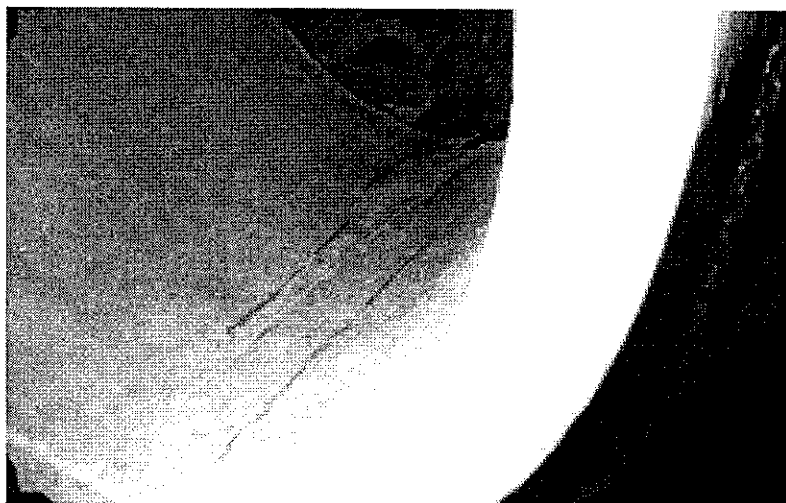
Muestra la falla producida en la tubería con diámetro de 42" y área de acero de refuerzo, la falla se produce a lo largo de la tubería, en la parte en que ésta se encuentra a tensión.
